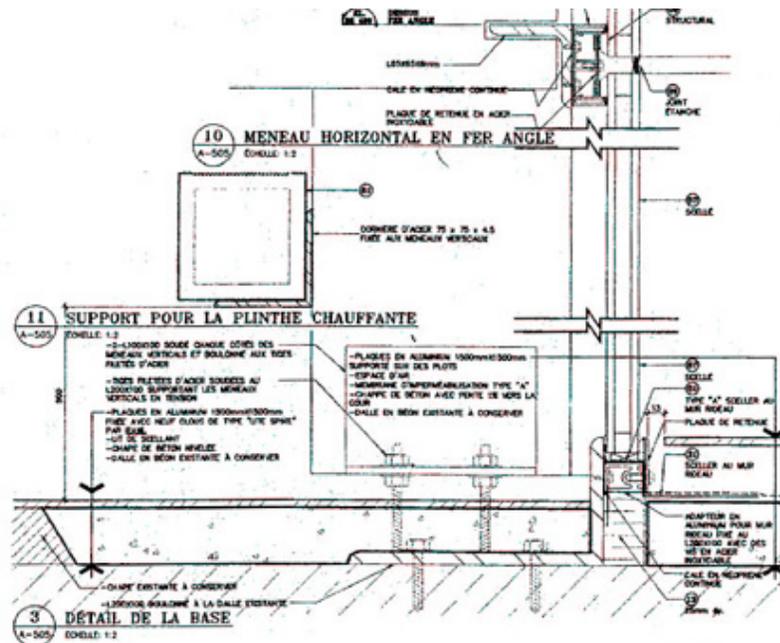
Détail en coupe verticale du support des plinthes de chauffage (Source : Dan S. Hanganu Architectes)
